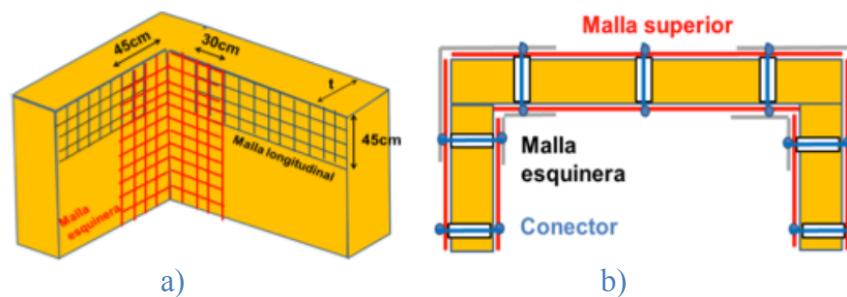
Malla longitudinal y traslape con malla esquinera; a) detalle en alzado y b) vista en planta (San Bartolomé y Quinn, 2015).
